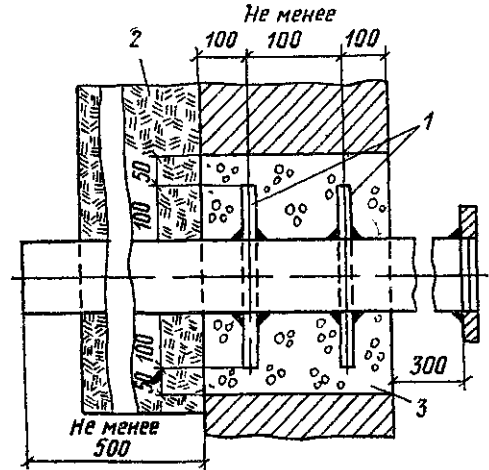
Ввод водопровода с ребристым патрубком через стену подвала во влажных и мокрых грунтах
